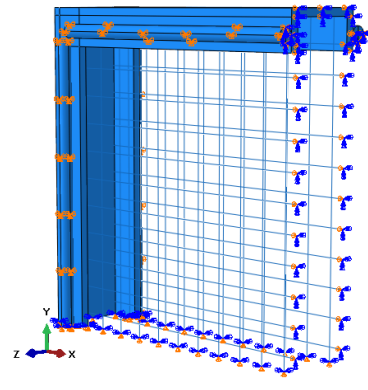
Cadre métallique et le maillage des armatures d'un quart de la dalle en béton
